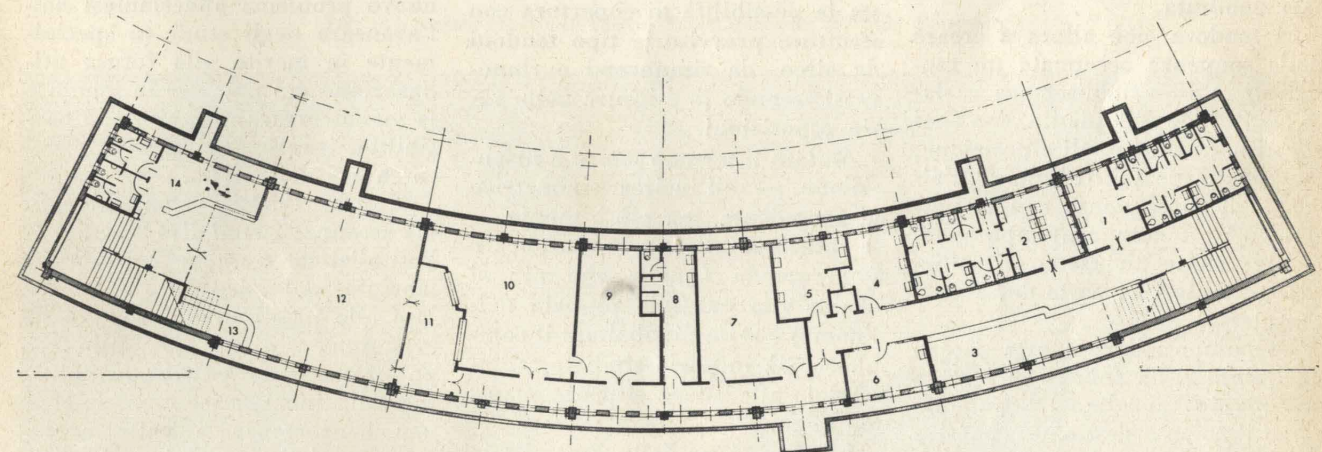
Pianta dei servizi sotto l'atrio d'ingresso.
